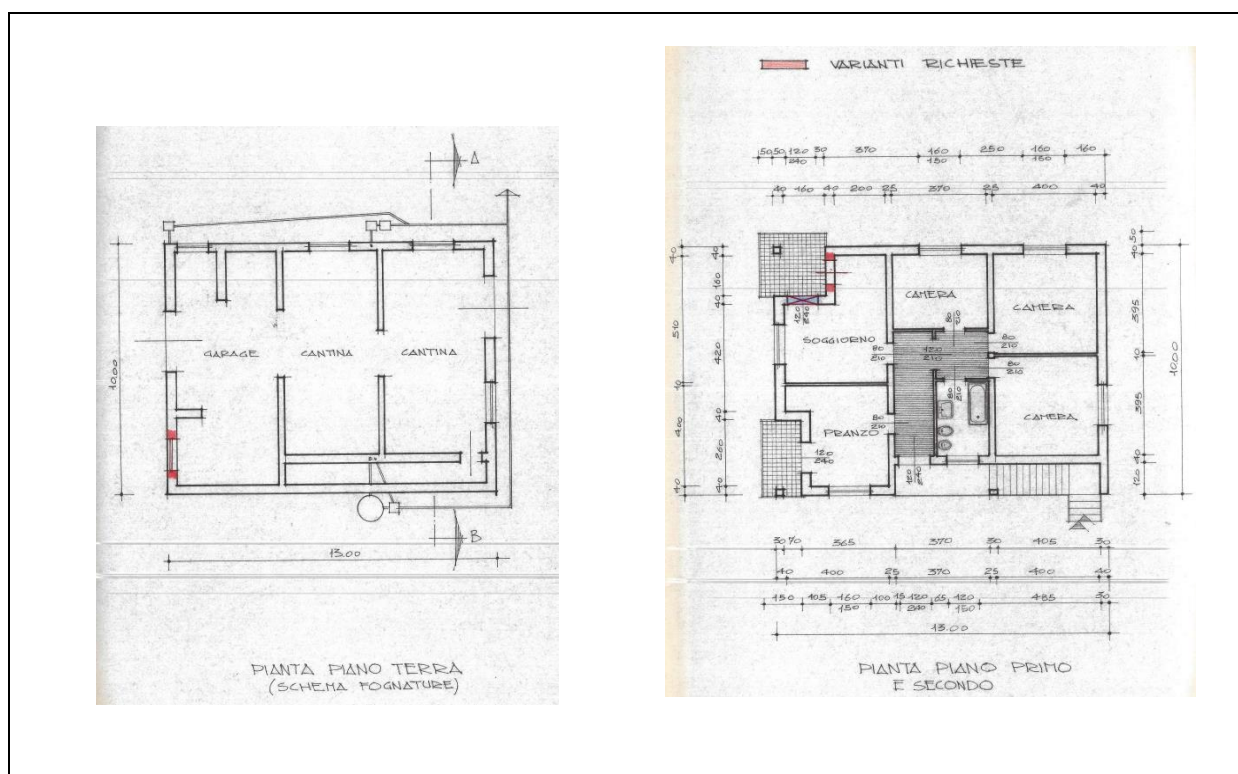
Planimetrie Concessione Edilizia Prot. N.1271 del 09/08/1978
